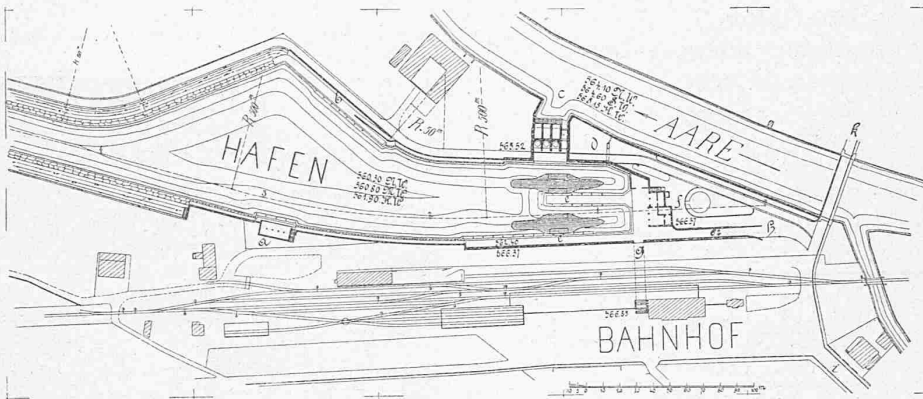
Lageplan der Hafenanlage in Interlaken. 1:4000.
